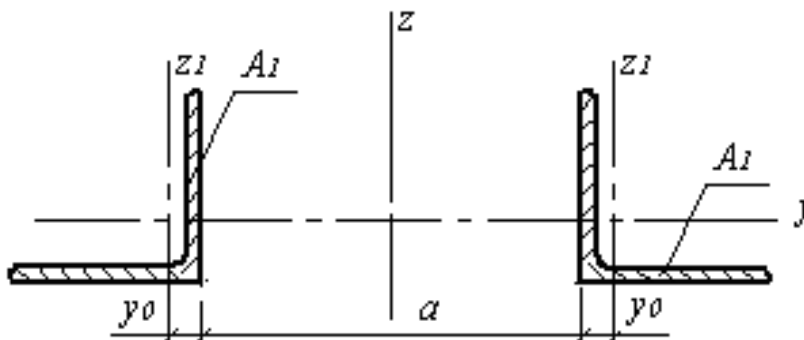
Сечение верхнего пояса фермы Фм-1
